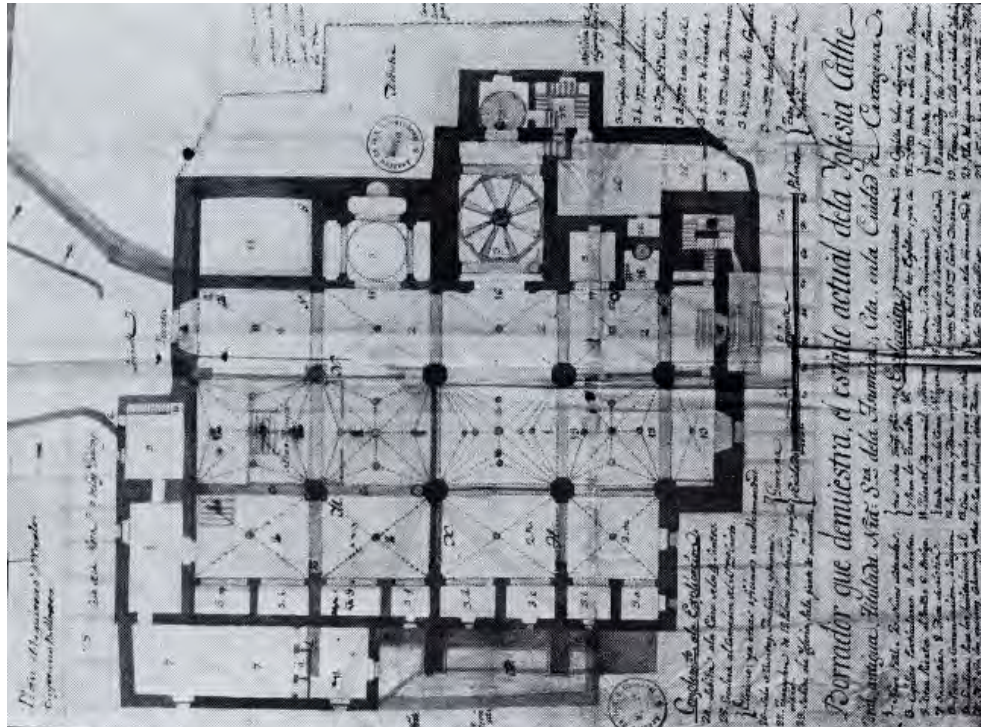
Plano de Carlos Cayetano Ballester, levantado en 1816 a instancias del Cabildo catedralicio (disposición del templo concebido bajo e patrón arquitectónico de iglesias de planta salón)
